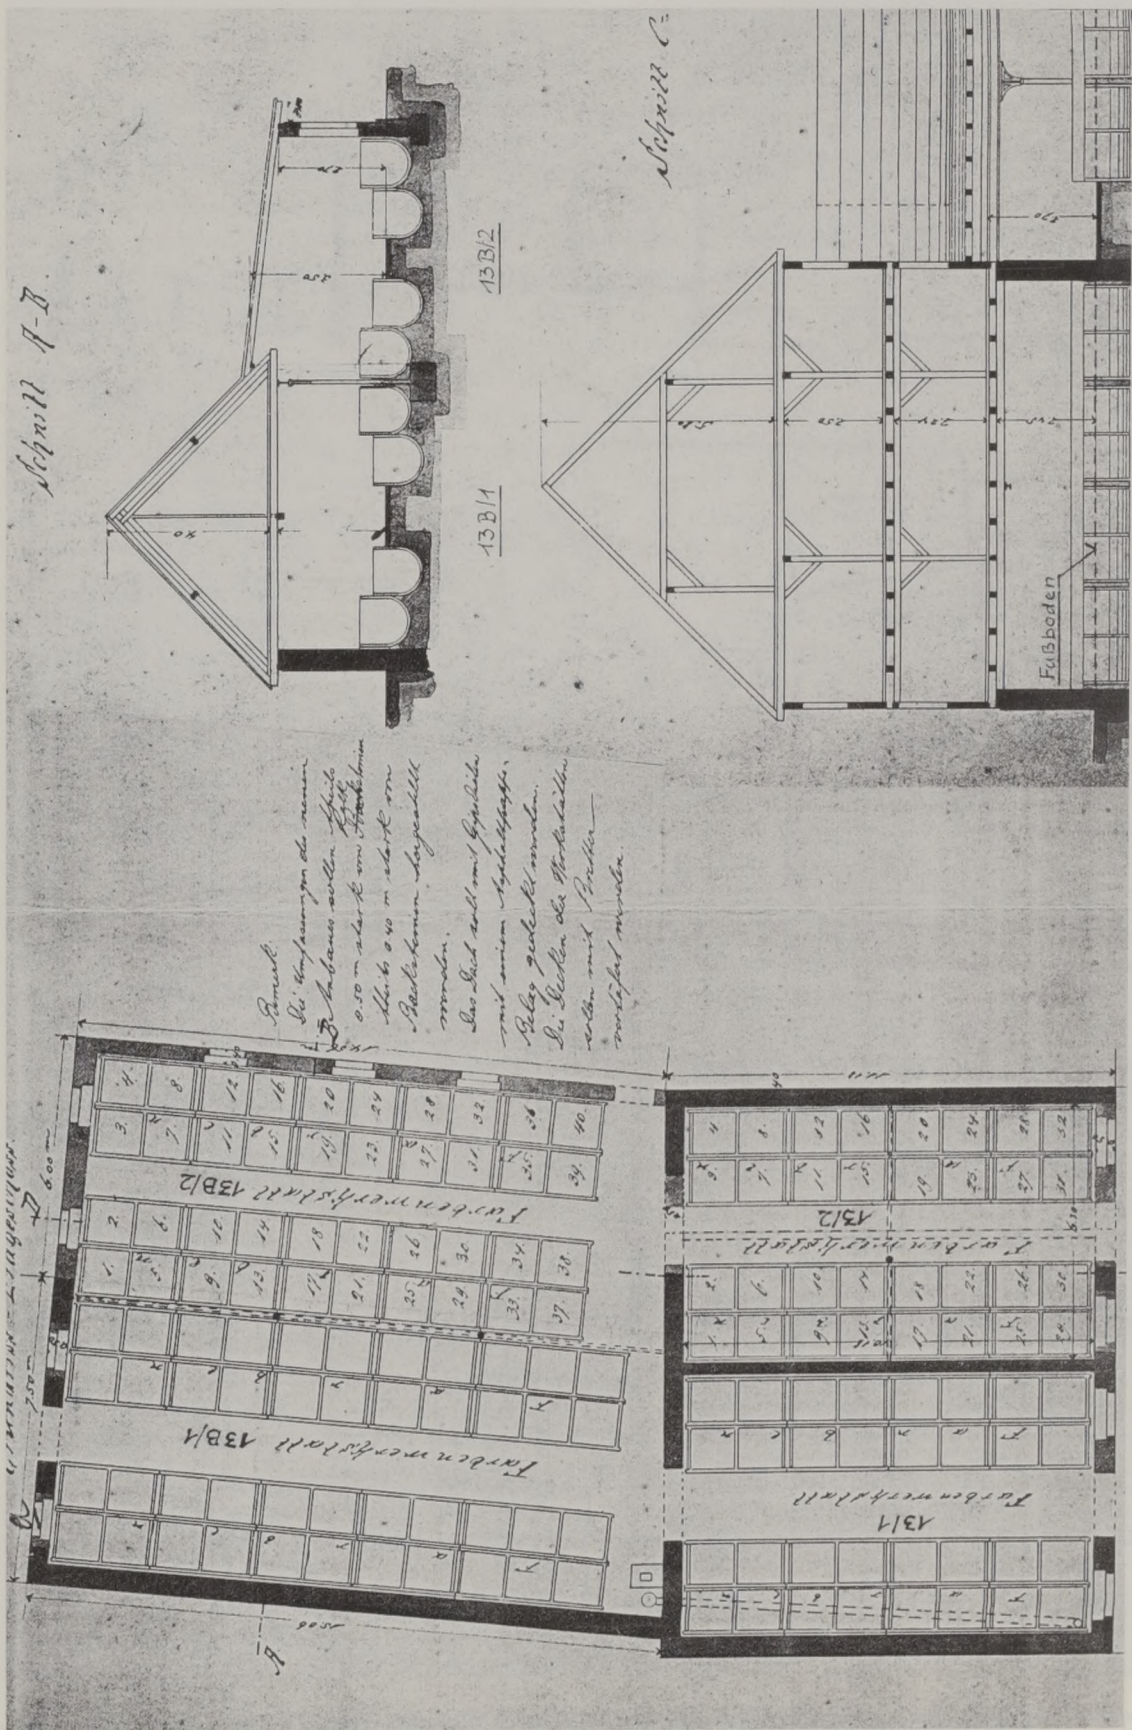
Grundriss und Schnitte durch die Scheuer 13 mit ihren EG-Anbauten (13B/1+2) von 1872 und 1892. Das gesamte Erdgeschoss war innerhalb von 17 Jahren zu einer zusammenhängenden Farbenwerkstatt mit insgesamt 148 Farben ausgebaut worden.
